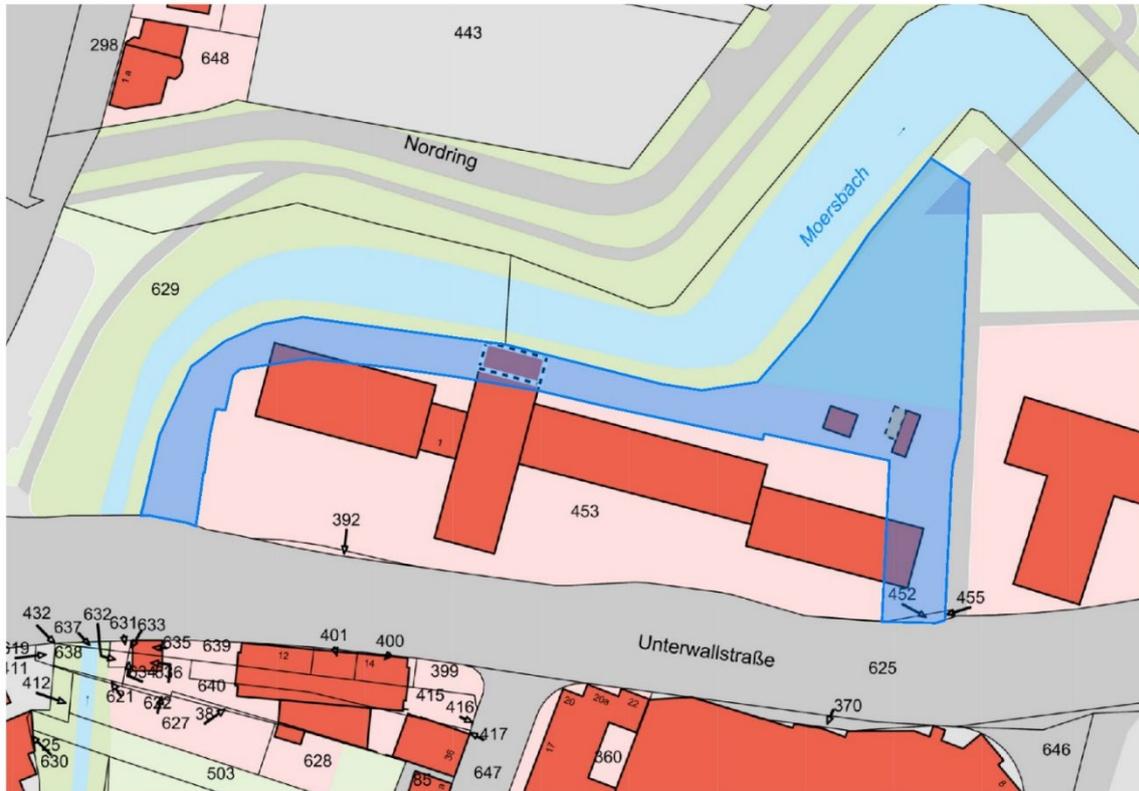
Lageplan mit Abgrenzung des Projektbereichs (öffentliche Grünfläche im BP 220)
